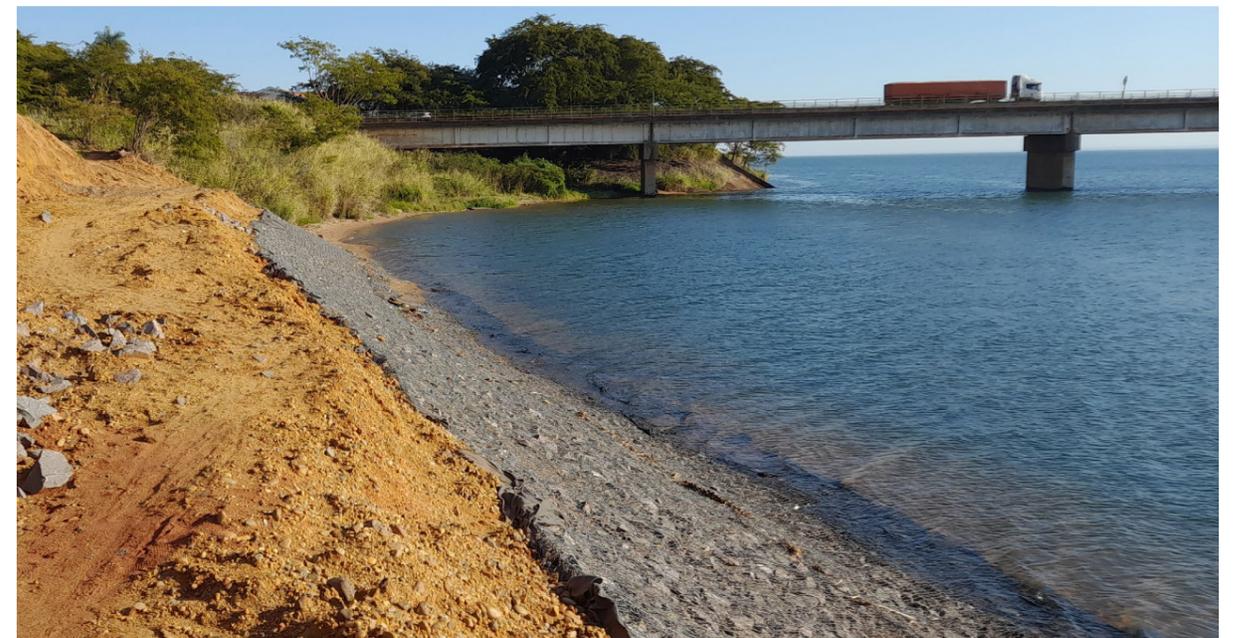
Gabião plano em Presidente Epitácio/SP (Acervo Belgo Soluções Geotech, foto: Flávio Fontes da Cruz, 2024).
